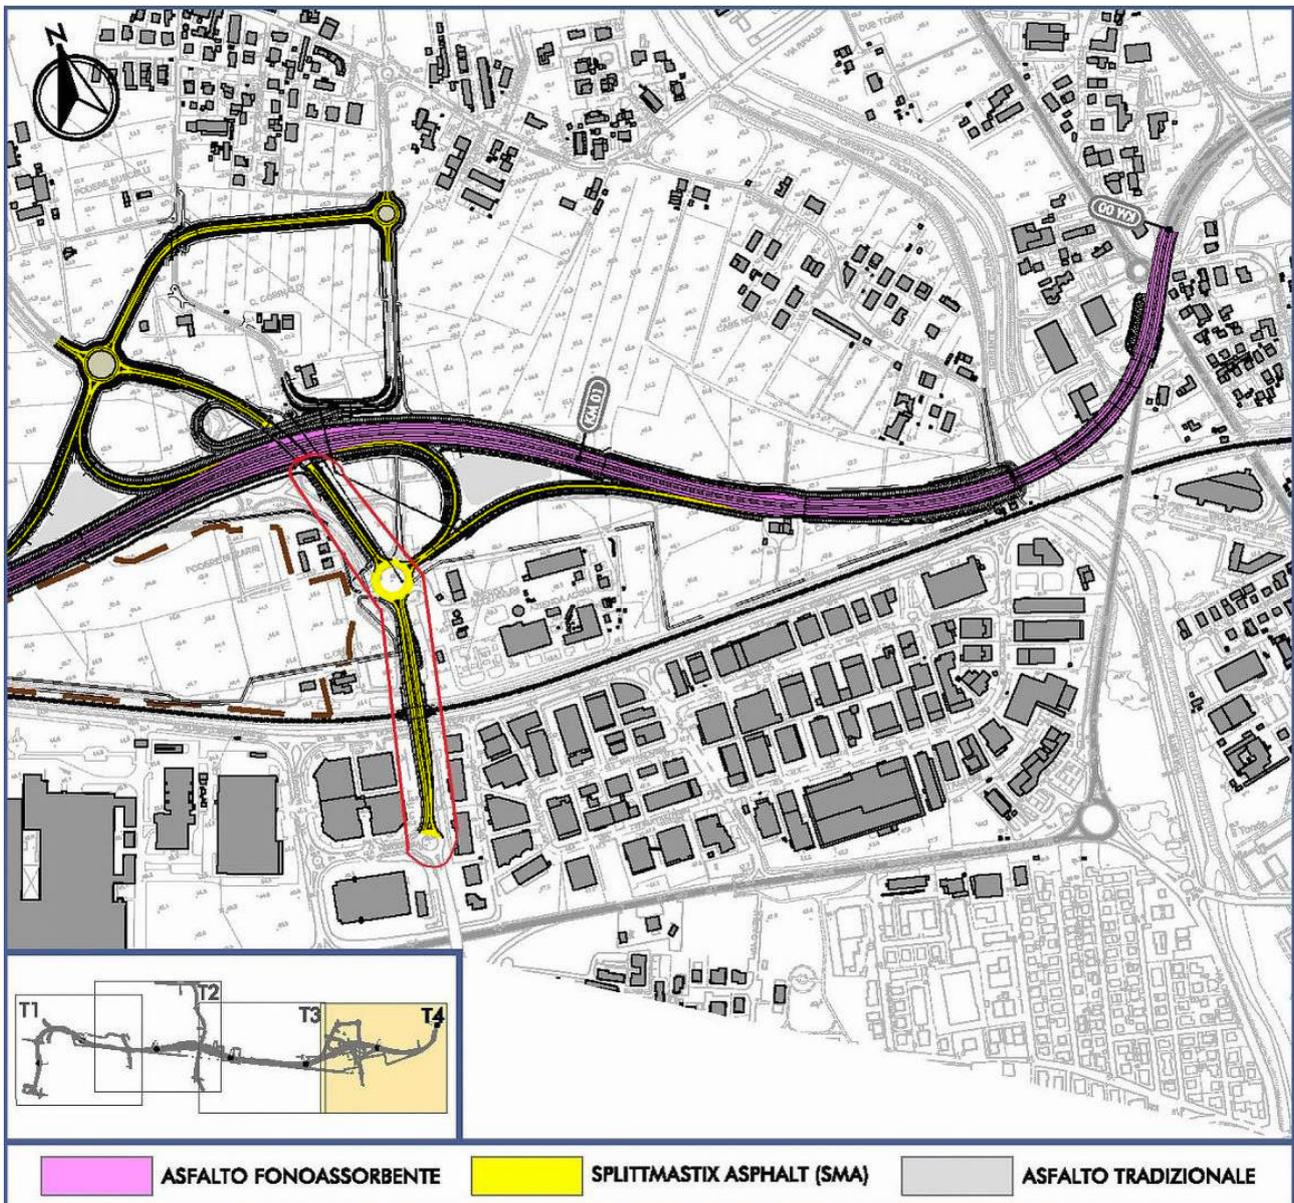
Pavimentazioni stradali di progetto nel tratto tra l'inizio intervento e la pk 1+800
